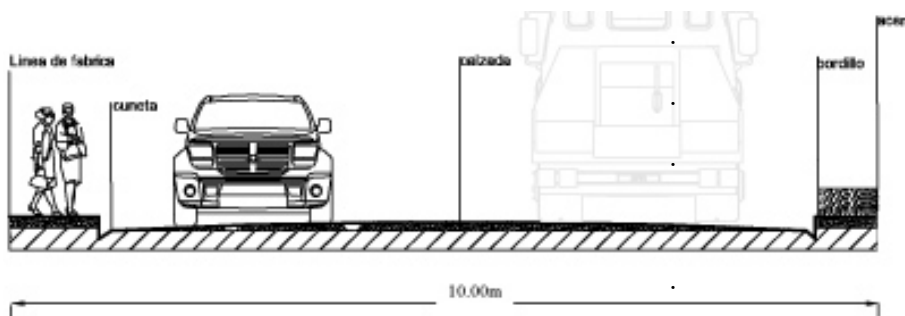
Sección 7. Calle Gonzalo Pizarro. Esc: 1:200
